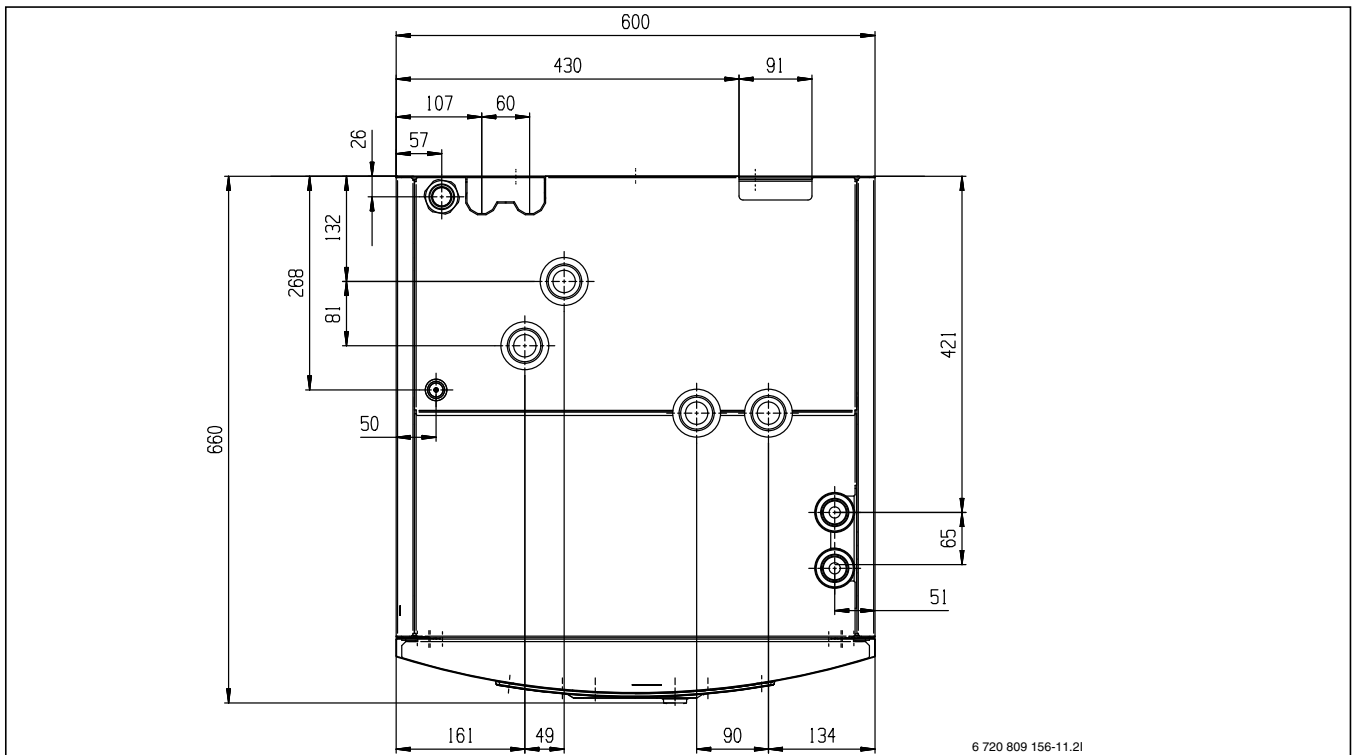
Abstände des Towers, Draufsicht (Maße in mm)
